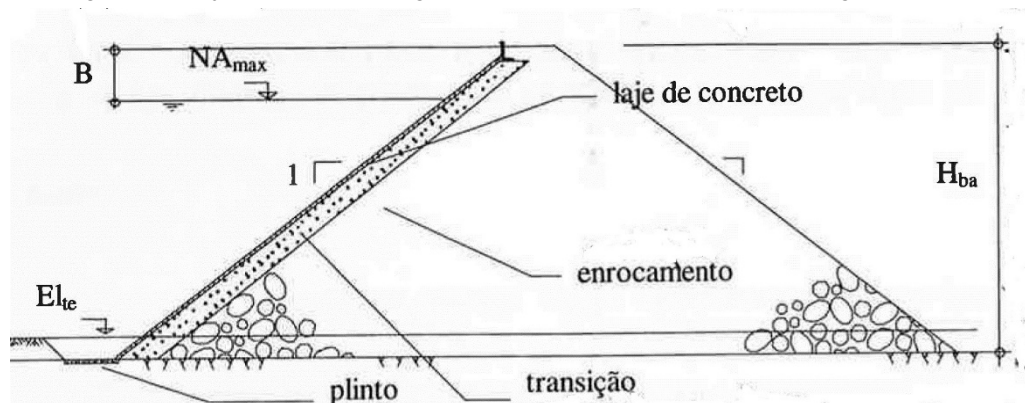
Seção típica da barragem de enrocamento com face de concreto
